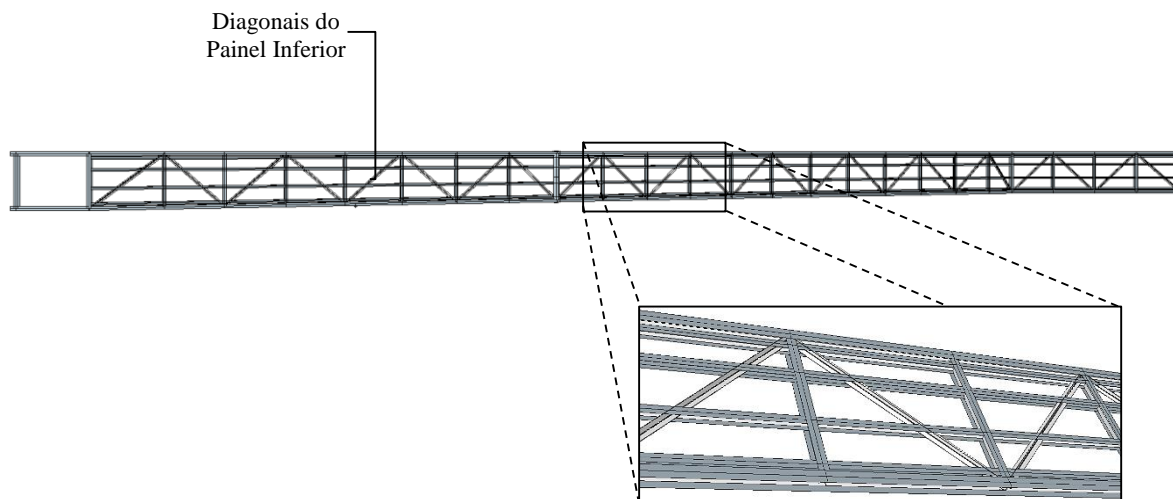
Identificação das Diagonais do Painel Horizontal Inferior
